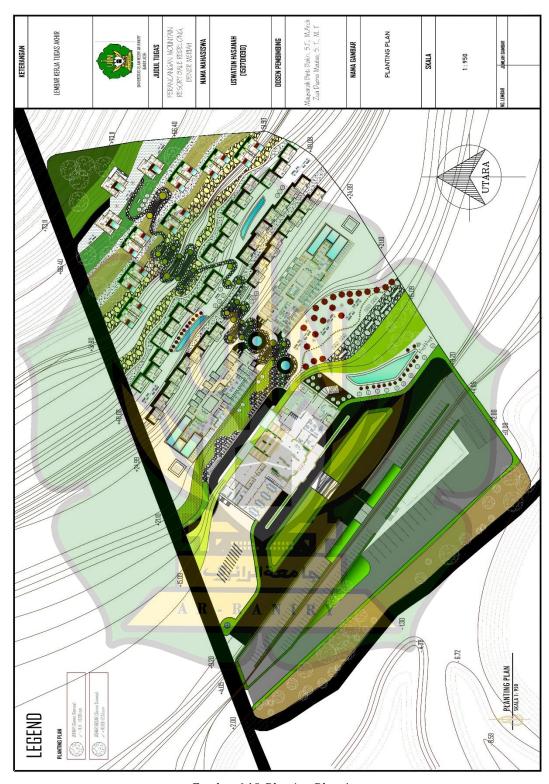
Planting Plan 1* Sumber : Rancangan Pribadi
